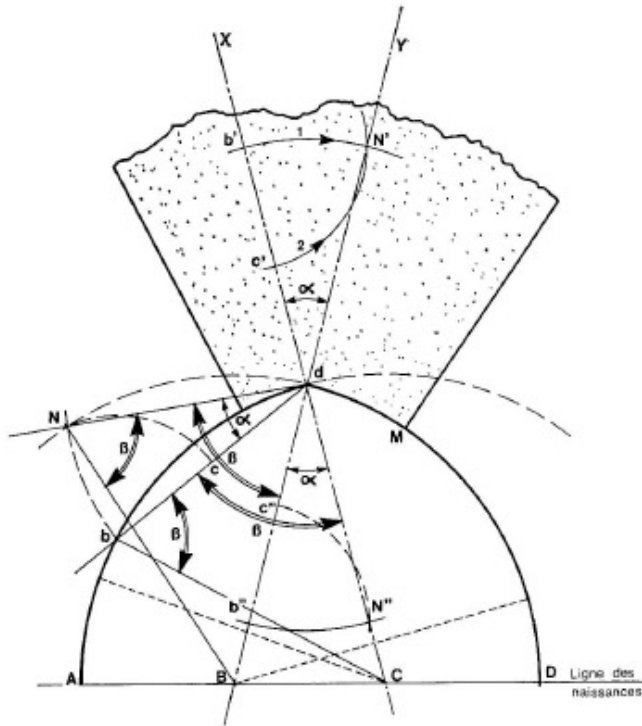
a. — LE TRACÉ SUR LA PIERRE
